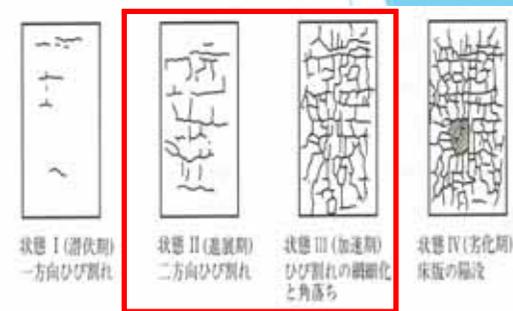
鉄筋コンクリート床版の下面のひび割れと劣化状態
